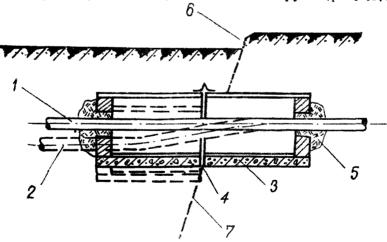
Схема устройства защитного канала на подземном стальном трубопроводе в месте образования уступа:
